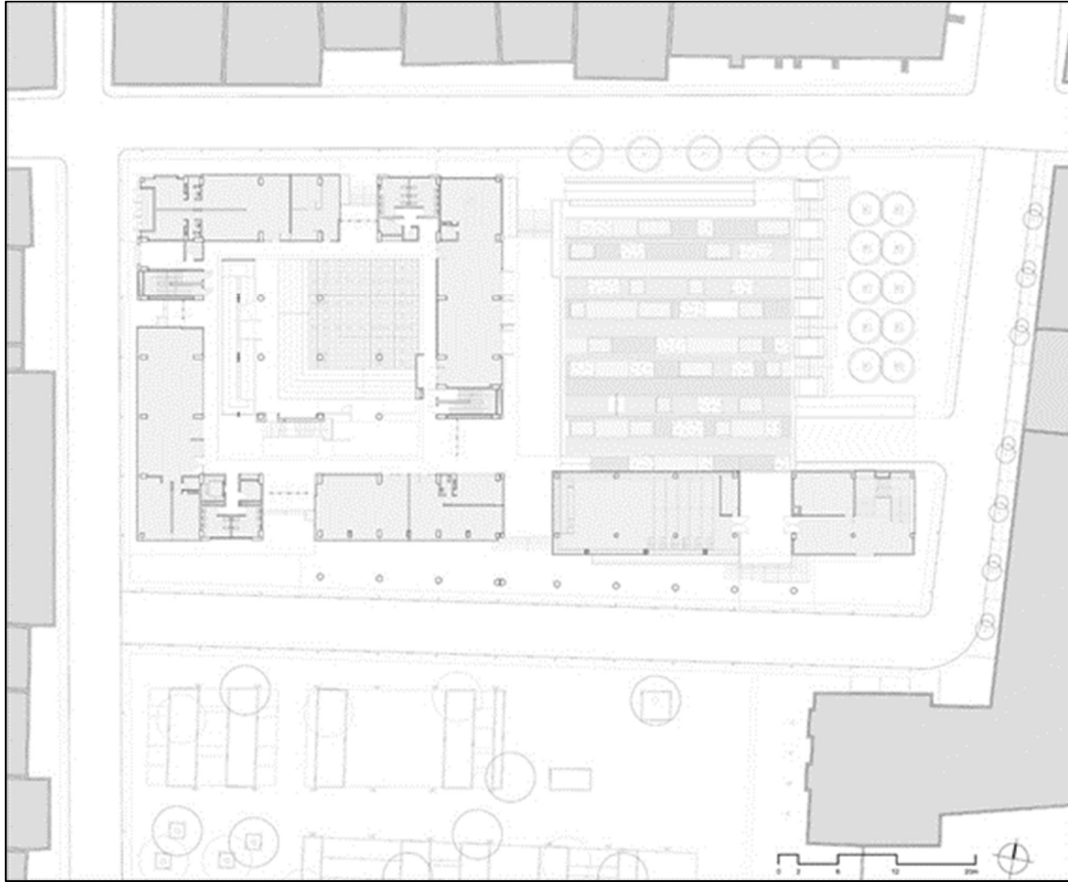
Planta Primer Piso / sede de Alcaldía de Baruta
